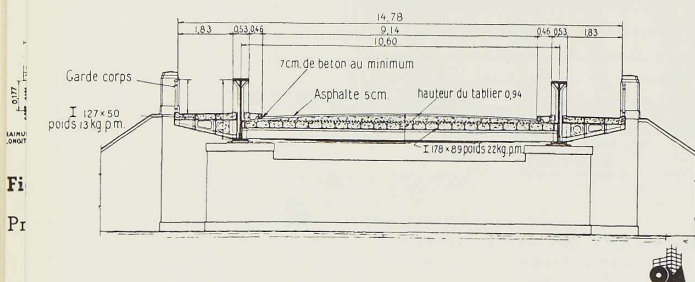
Coupe transversale. Cross section. Querschnitt.
